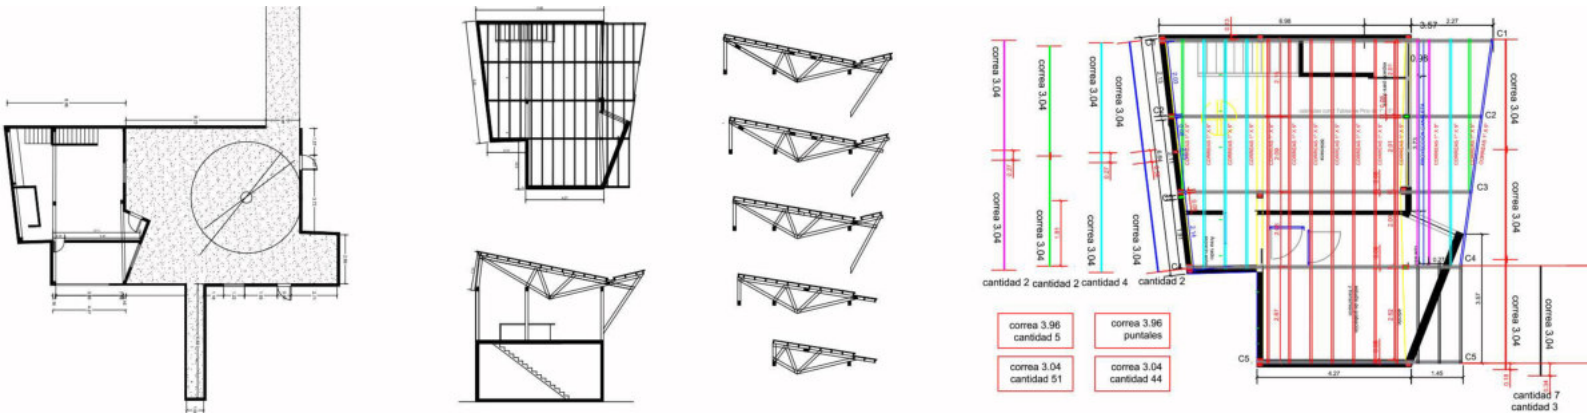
Acceso desde la calle a la planta baja existente. 5 cabriadas compuestas. Detalle de los elementos en colores para indicar los cortes en obra.
